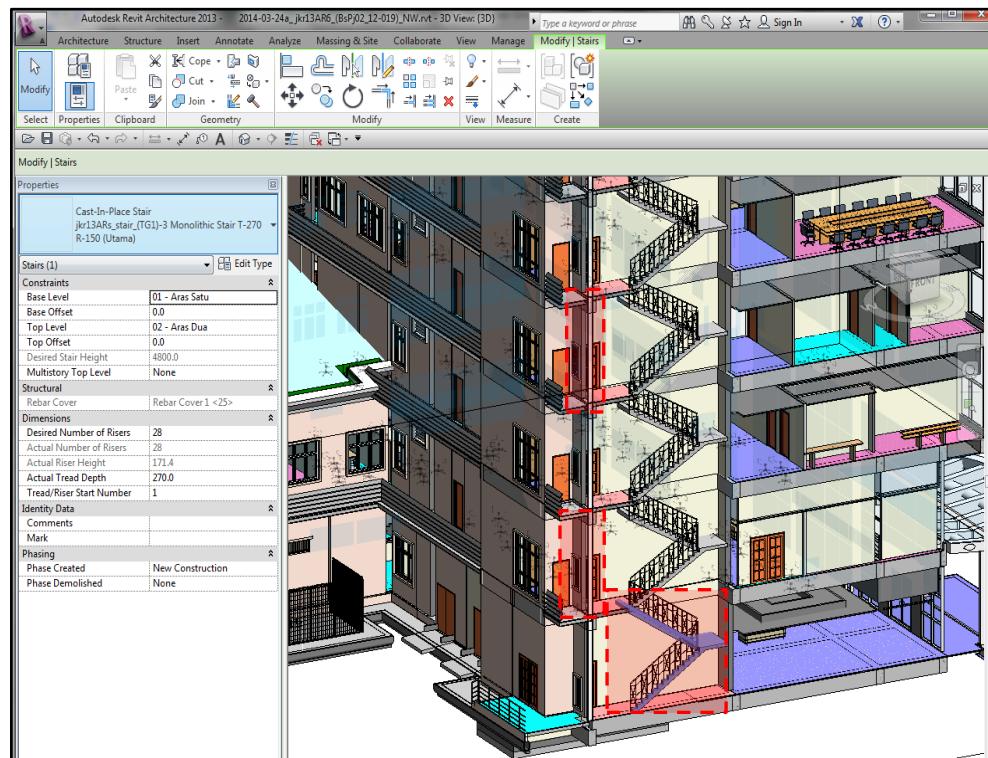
Contoh Work Breakdown Structure (WBS) yang diasangkan mengikut aras bangunan
